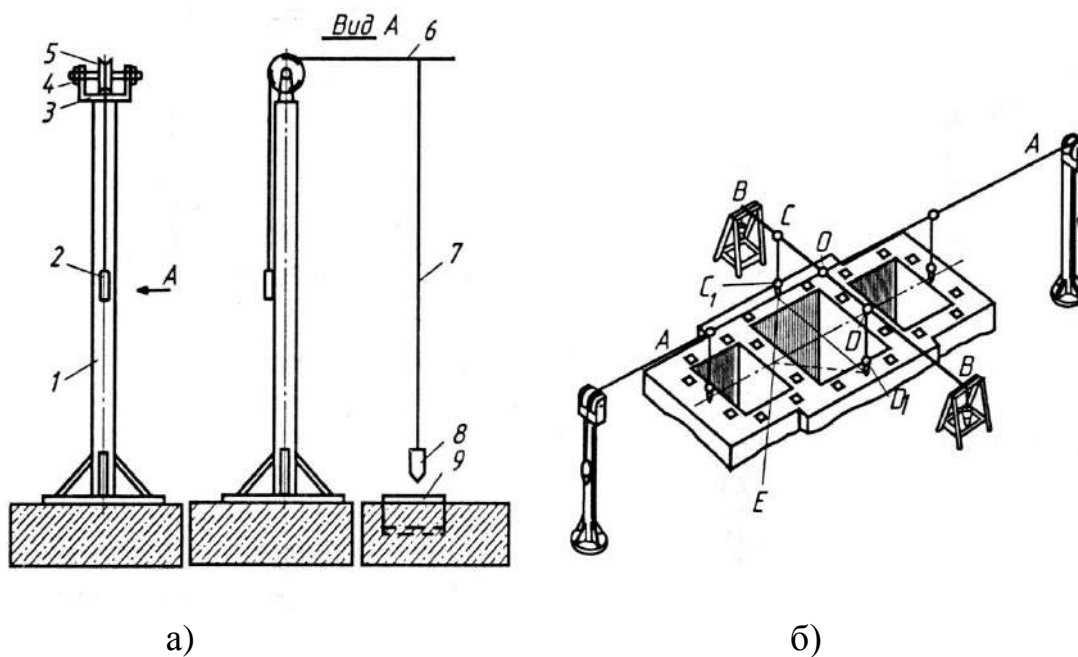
Схемы приспособлений и разметки (а – оседержатель; б – разметки главных осей фундамента): 1 – стойка; 2 – груз; 3 – скоба; 4 – гайка; 5 – несущий ролик; 6 – струна; 7 – нитка; 8 – отвес; 9 – осевая плашка; А-А – главная продольная ось; В-В – главная поперечная ось
